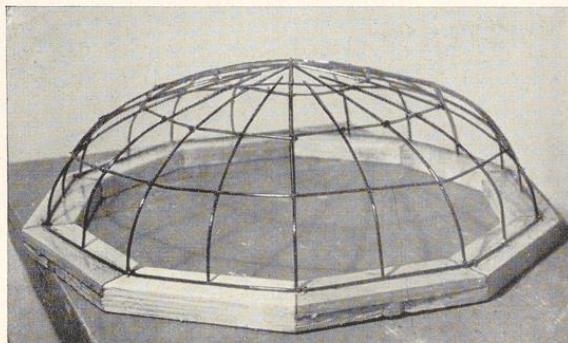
Geschlossenes Kloster gewölbe über einem Zehneck Grundriss. Bogenlinie ein Korbbogen mit 5 Einsatzpunkten
